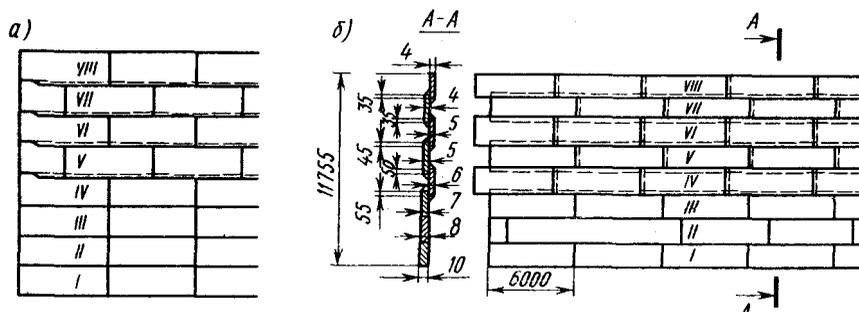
Схемы расположения листов корпуса резервуара вместимостью 5000 м³:
